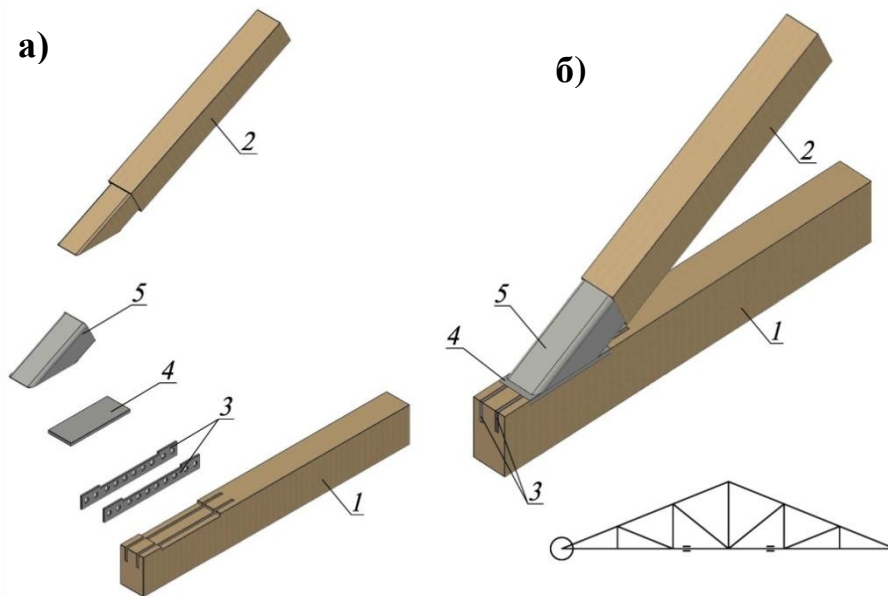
Опорный узел фермы на плоских стальных стержнях в разобранном (а) и собранном (б) виде: 1 – нижний пояс; 2 – верхний пояс; 3 – плоский стержень; 4 – опорная плита; 5 – стальная обойма
